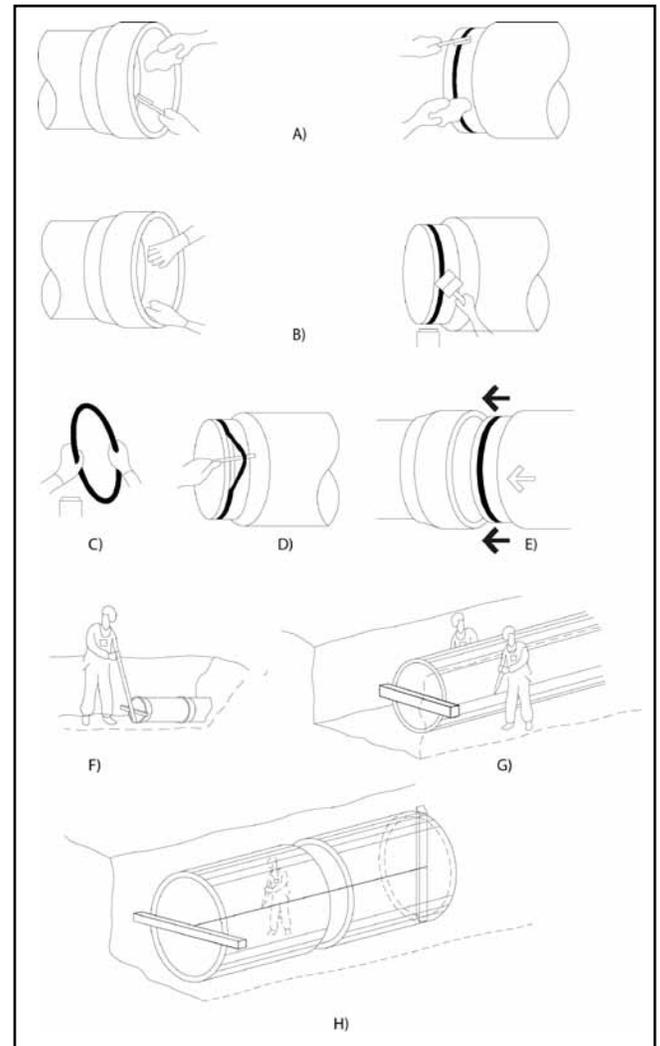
Instalación de tubería de concreto simple o reforzado
